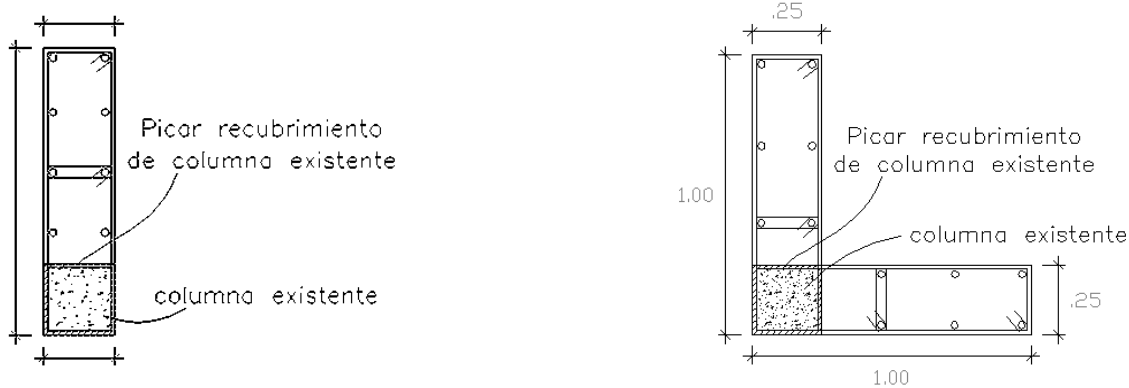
Detalle de reforzamiento para columna existente y esquinera
